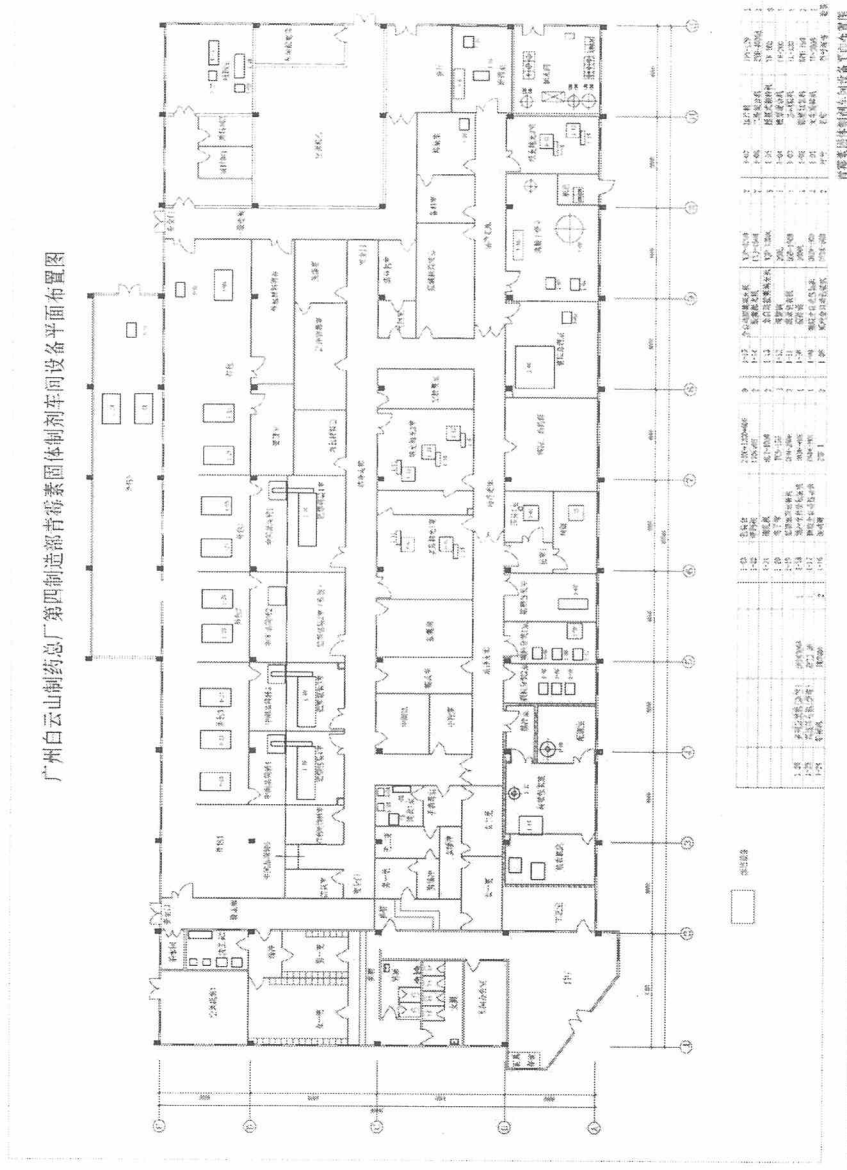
青霉素固体剂车间设备平面布置图
